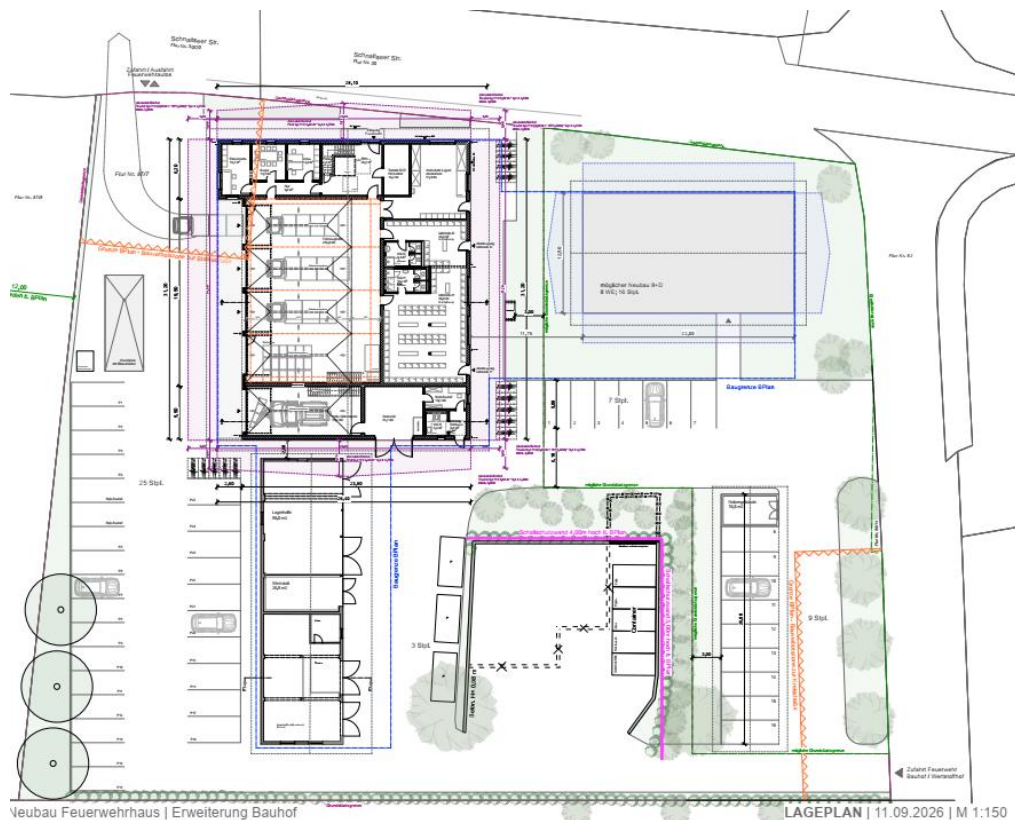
Planentwurf des Änderungsbereiches – ohne Maßstab.
